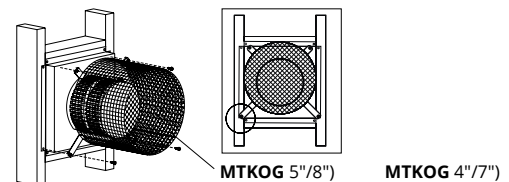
f Installation d'une grille thermique sur un chapeau MTO.
